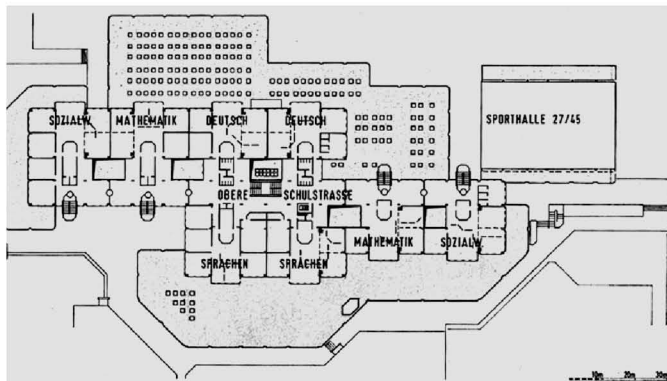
IGS Braunschweig-West: Grundriss Obergeschoss (Pysall, Jensen, Stahrenberg 1976, S. 331)
